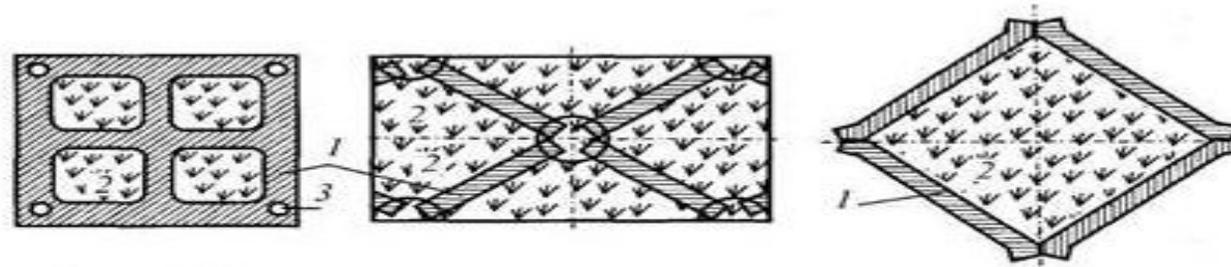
Железобетонные обрешетки для укрепления откосов:
